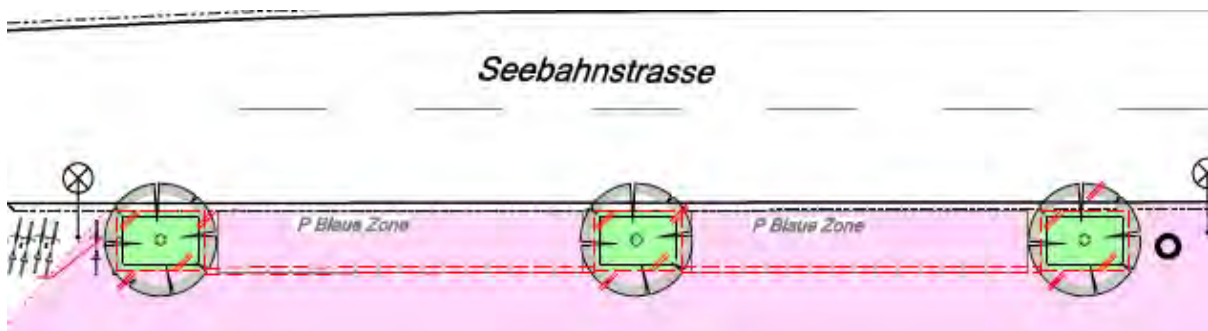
Planausschnitt Pilotprojekt Seebahnstrasse – erweiterte Baumgruben unter Parkplatz
